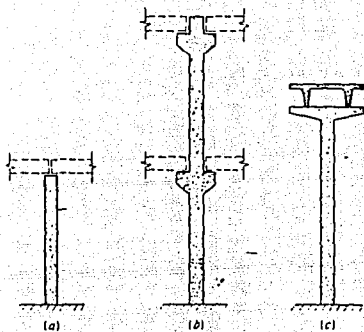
COLUMNAS PREFABRICADAS DE CONCRETO.
